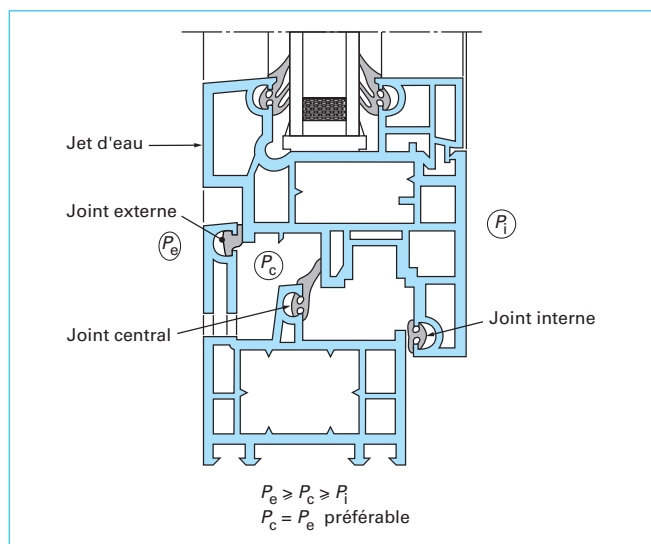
Exemples d'étanchéité à l'air entre ouvrant et dormant
